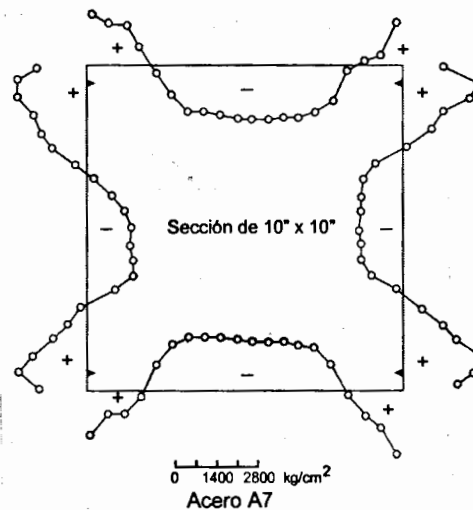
Esfuerzos residuales en secciones cajón soldadas.
